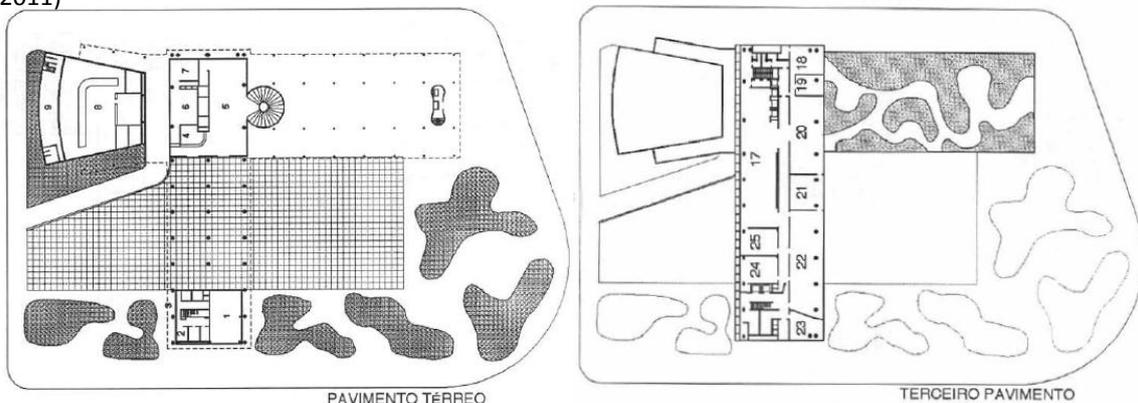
plantas do pavimento térreo e terceiro pavimento da proposta definitiva para o Ministério (FONTE: COMAS, 2002a)
